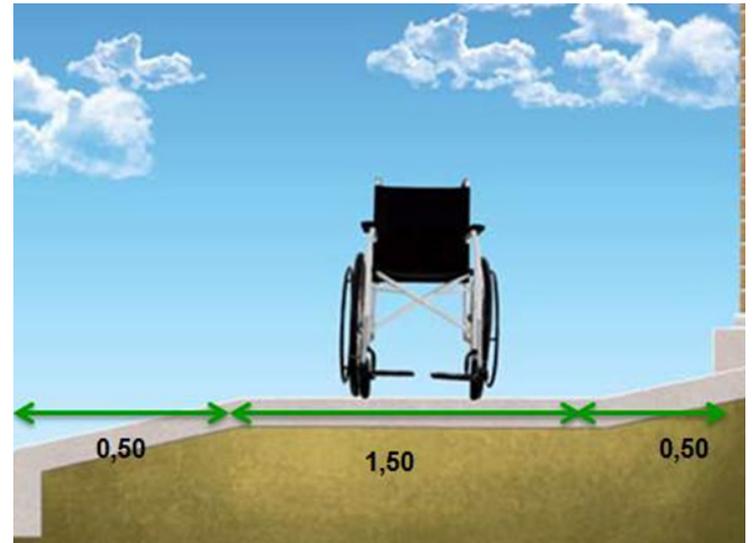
Croquis esquemático de Calçadas Verdes - corte
